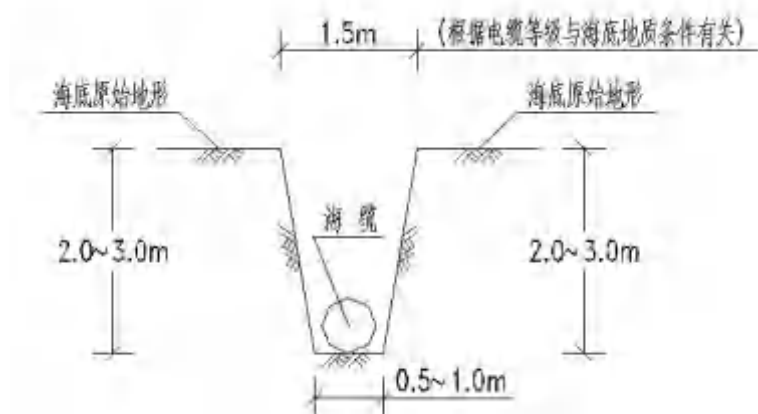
电缆正常敷设冲挖断面示意图
